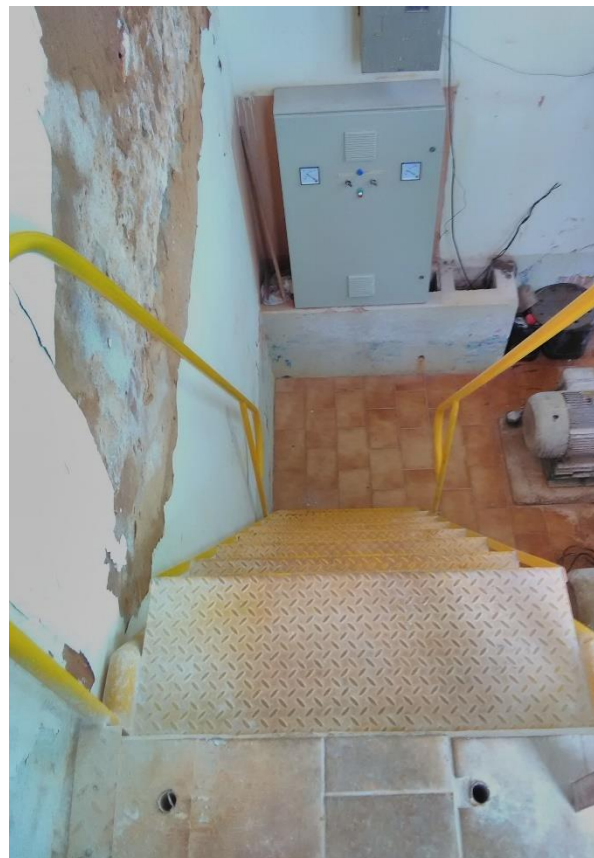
Frente quadro de comando Foto 90 – Elevatória sede elevatória (sede)
